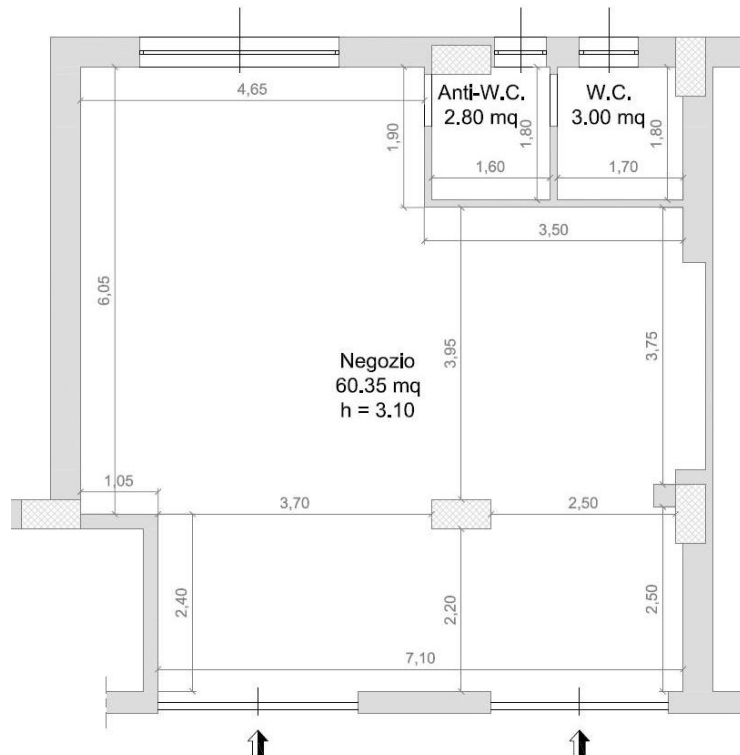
Planimetria Catastale Foglio 30, p.lla 2169, sub 104.
